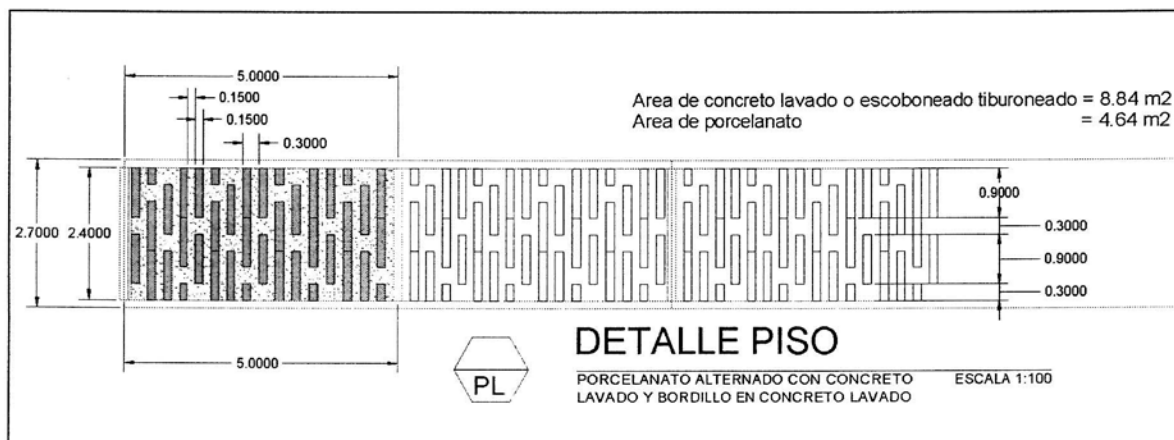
Detalle de acabado de piso incorporado en planos finales.
